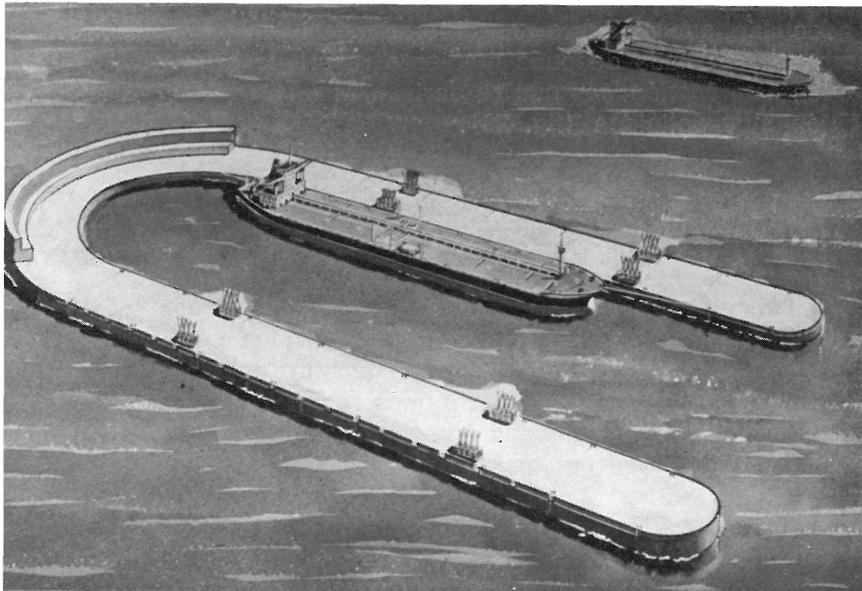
Proyecto de muelle flotante de abrigo y distribución, constituido por cajones ensamblados de hormigón pretensado.
